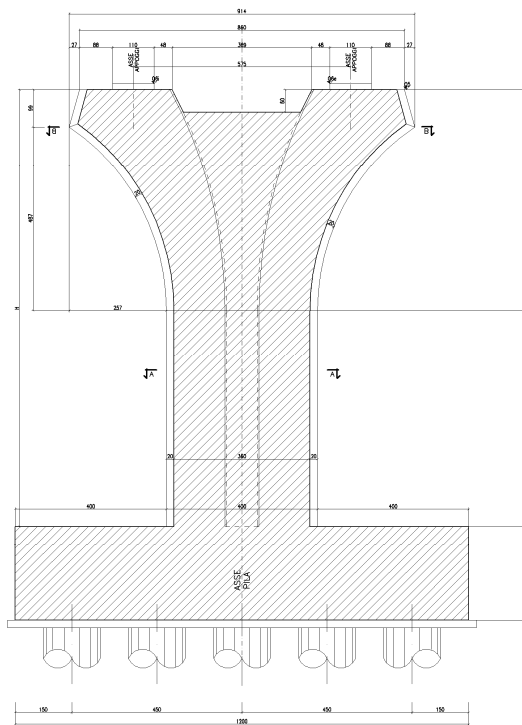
Sezione trasversale con fondazione tipo B.
